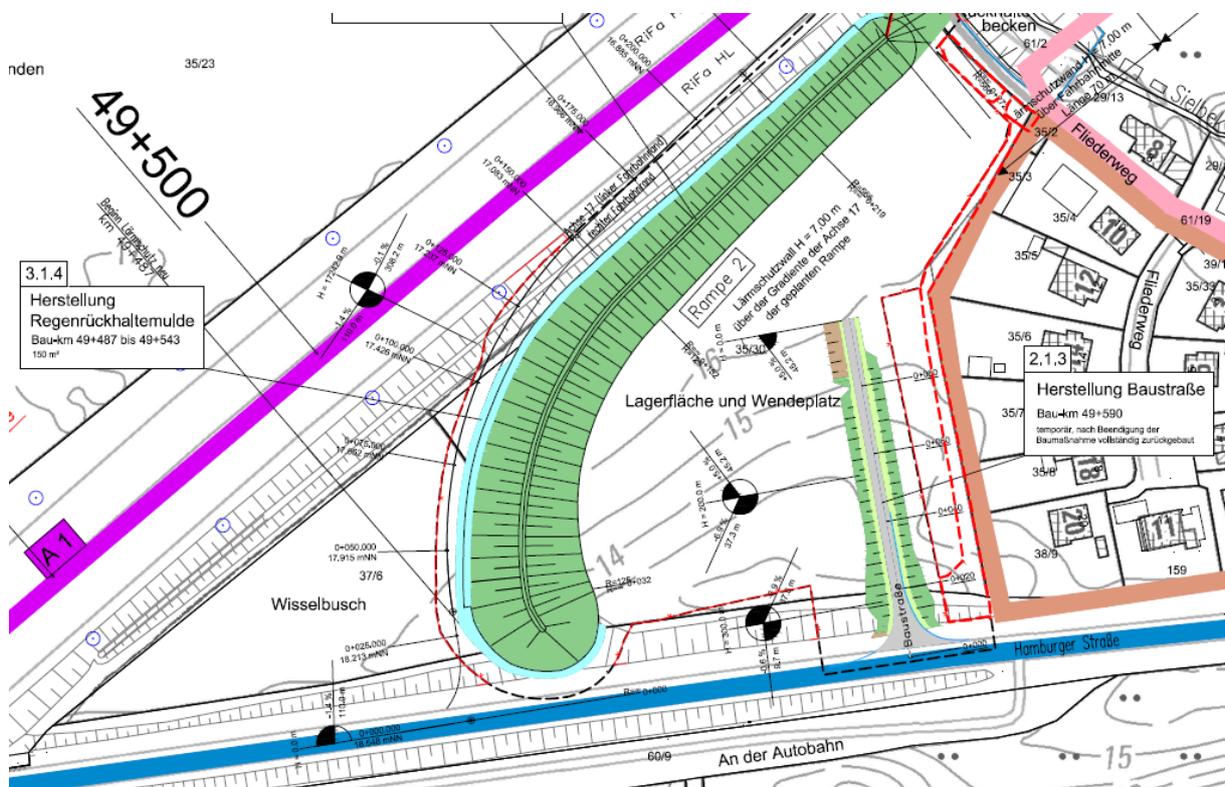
Zufahrt zum Baufeld von der B 75 (Ausschnitt aus dem Lageplan, Unterlage 5/1)
